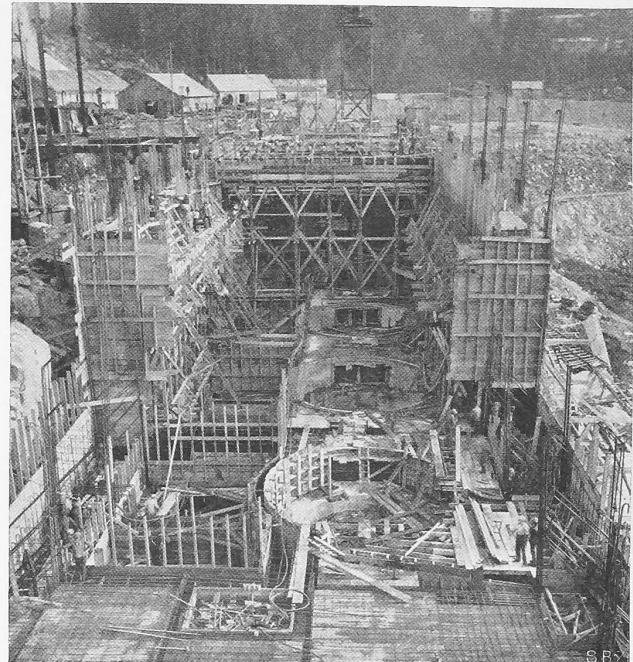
Blick in die Baugrube des Maschinenhauses.
